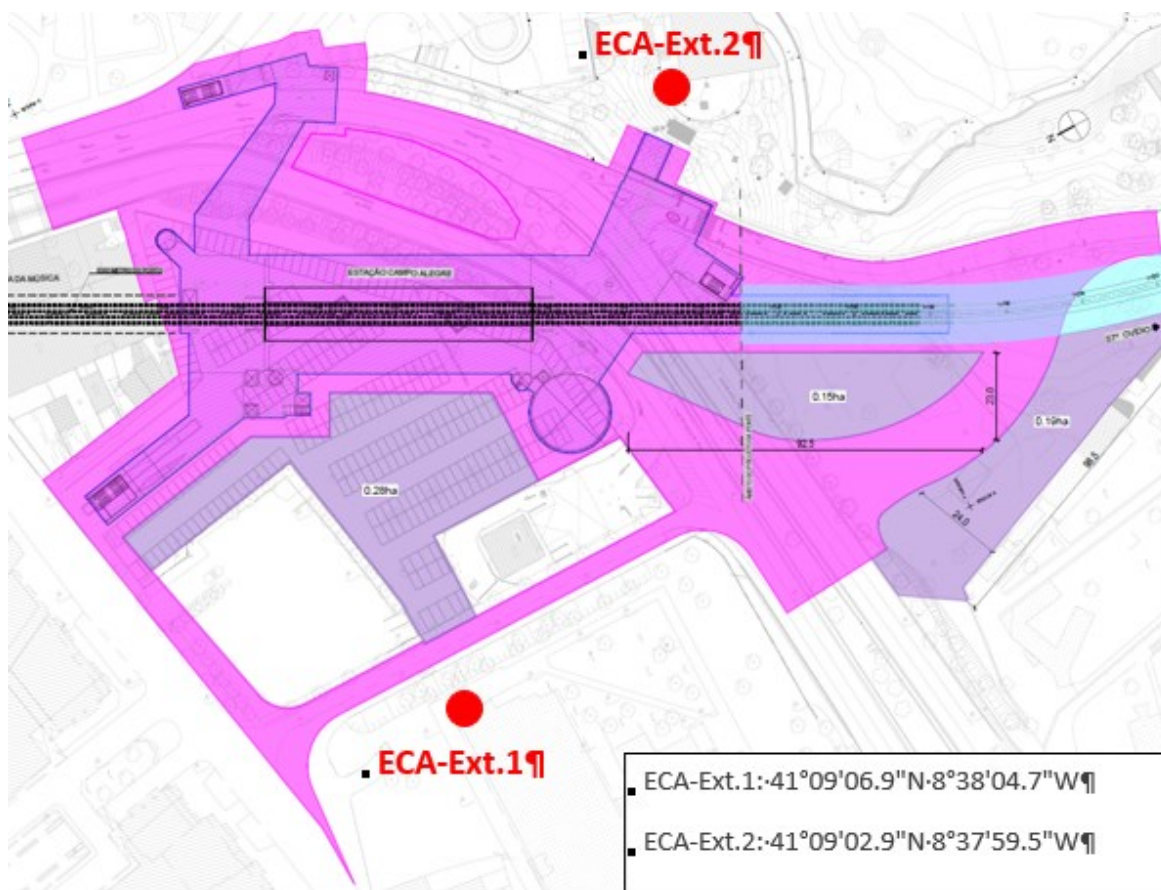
Pontos de monitorização junto Estação Campo Alegre (vibrações – construção)
